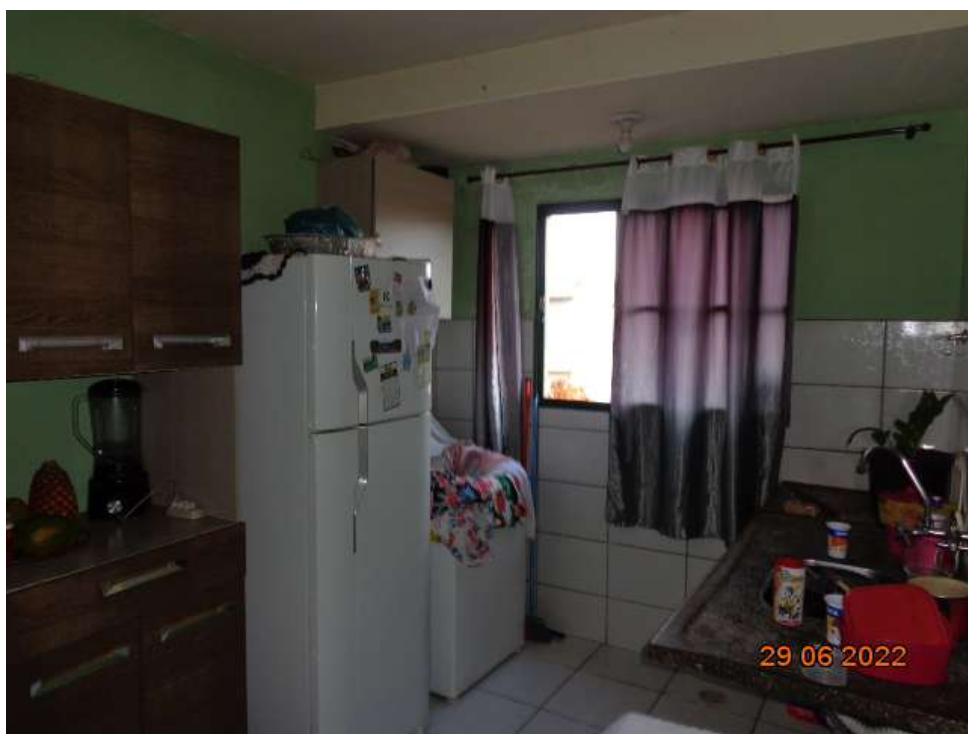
Imagem da cozinha onde se vê ao lado da geladeira, a maquina de lavar Roupas. Já citado que sob a pia encontra-se um botijão de gás que alimenta o fogão ao lado da pia
